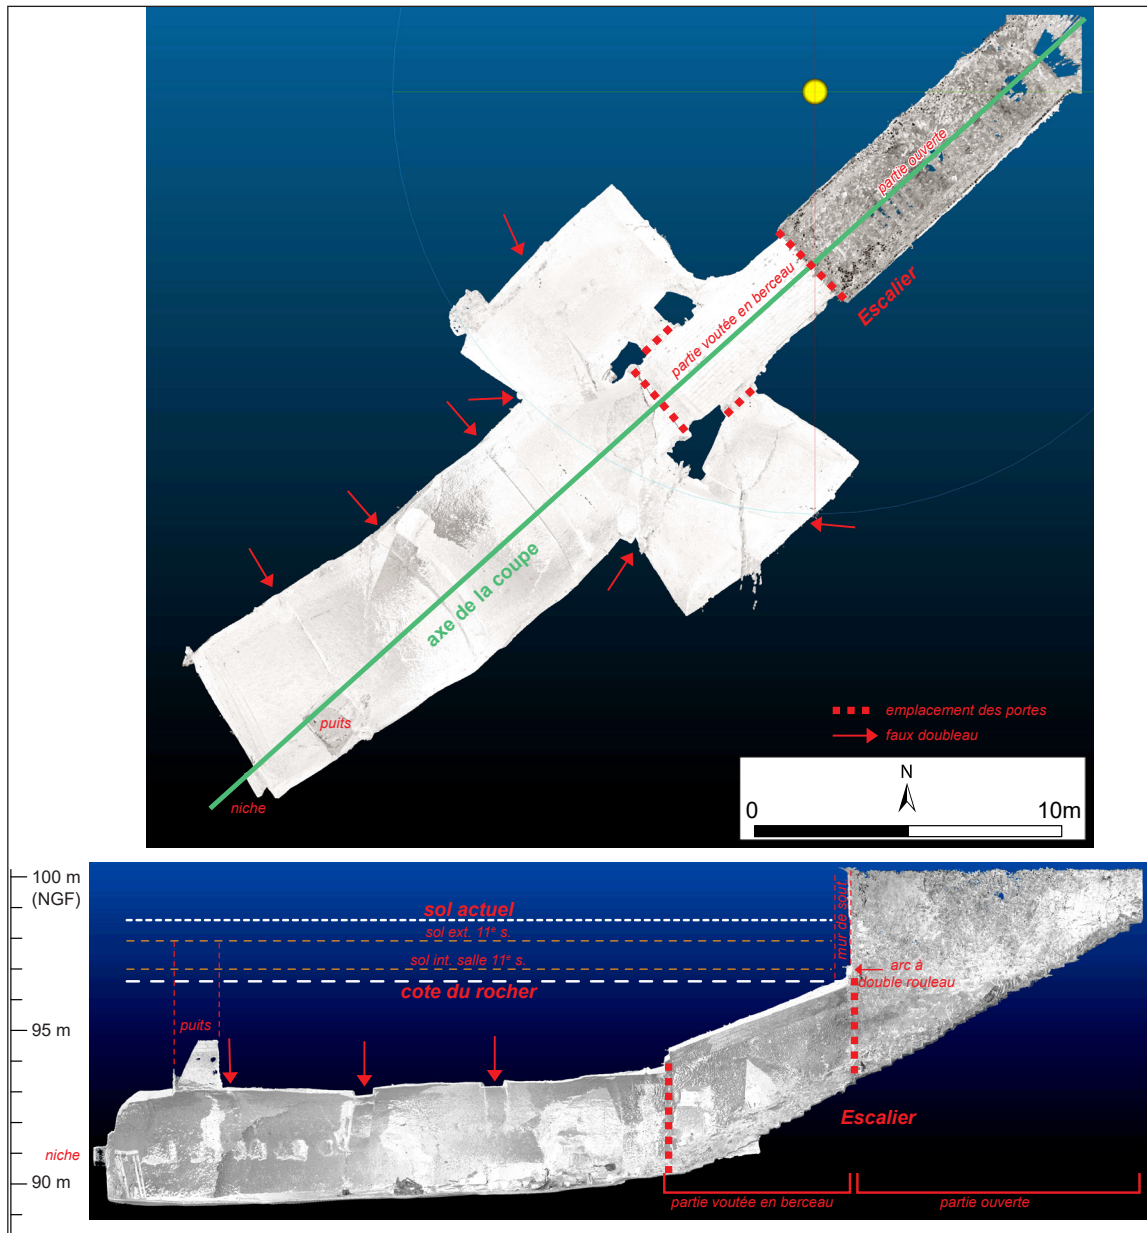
plan et coupe issu du scan 3D de la cave située à proximité de la grande salle (cellier ?)
